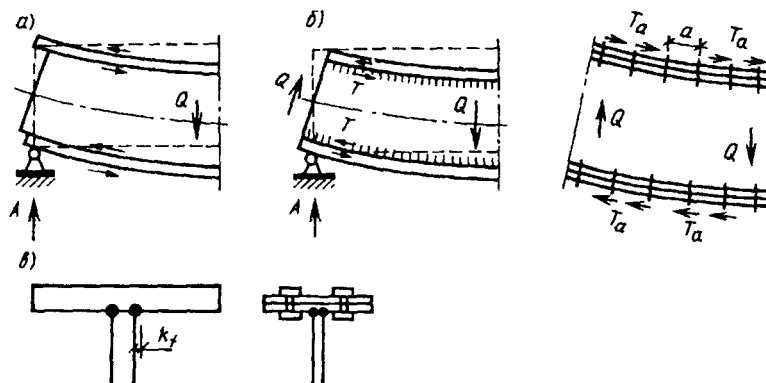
Работа поясных соединений — поясных сварных швов и болтов
